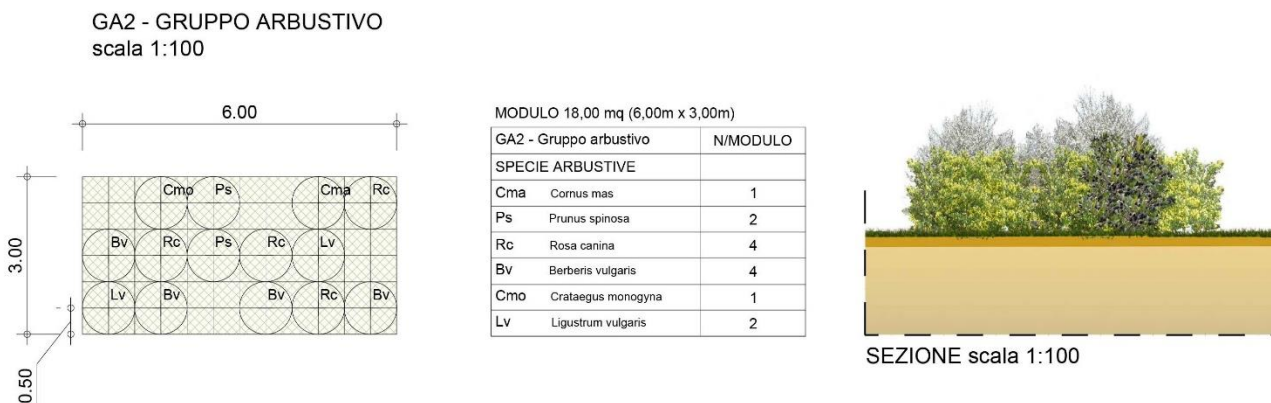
Pianta e sezione gruppo arbustivo tipo 2
